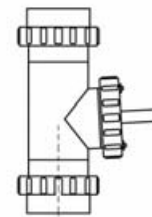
Élément d'inspection sur conduit vertical
